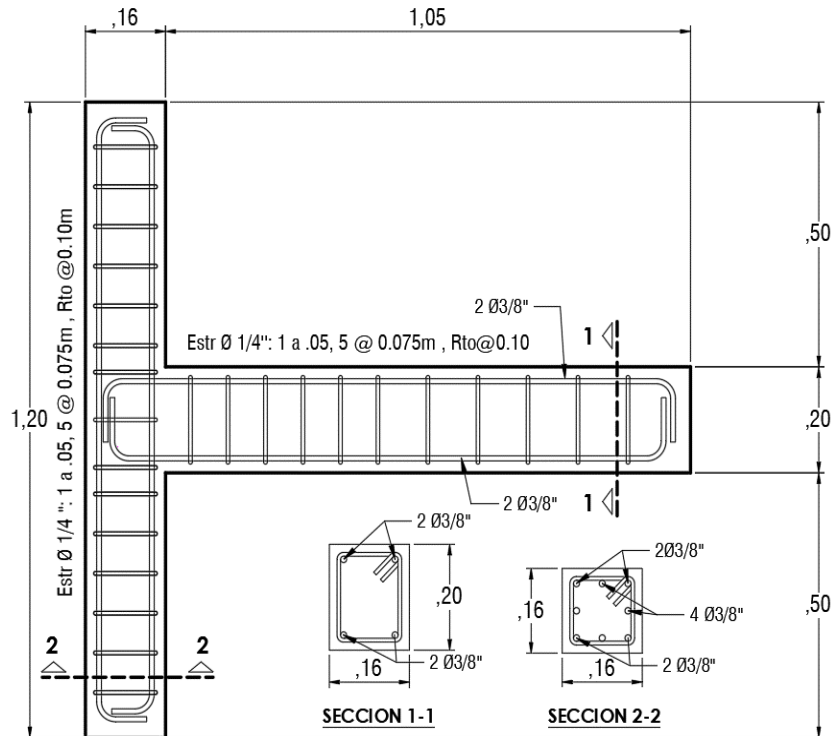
PLANO DEL MODELO ESPÉCIMEN SIN REFORZAMIENTO
